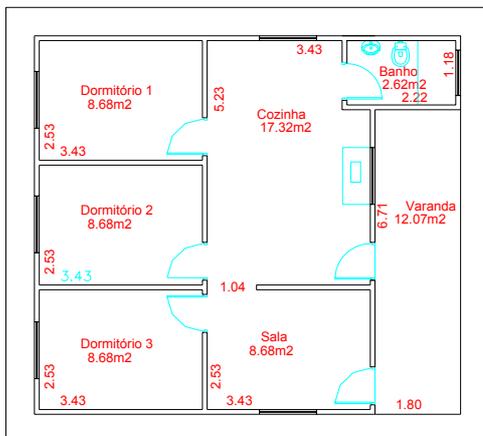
Projeto Tipo 1 do Assentamento Pirituba.
